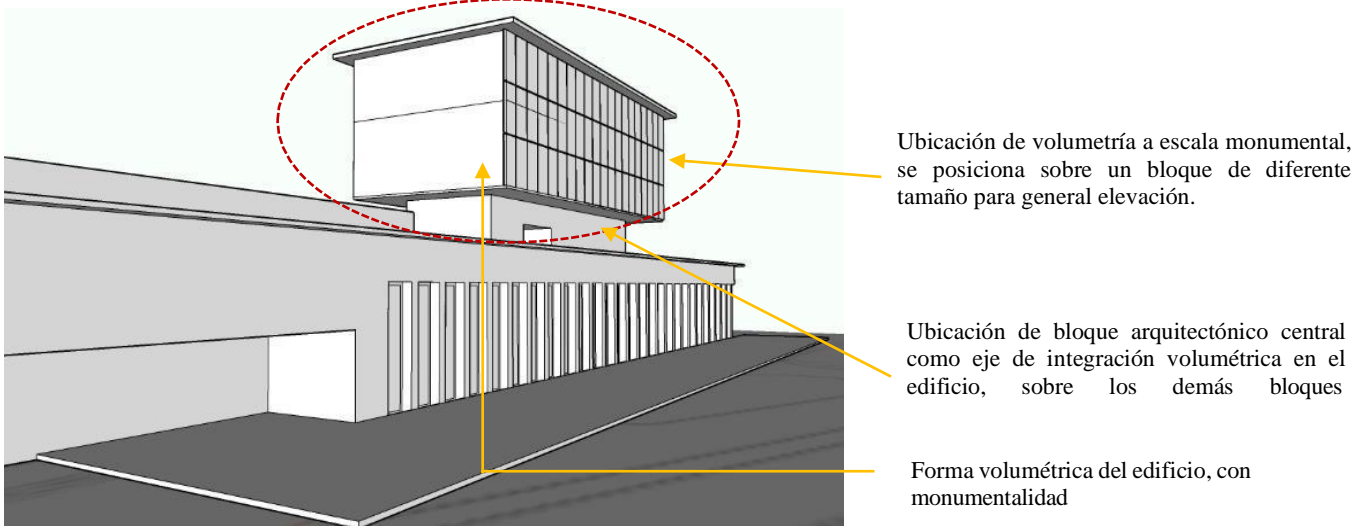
Fachada exterior del edificio-ISOMETRIA 1
